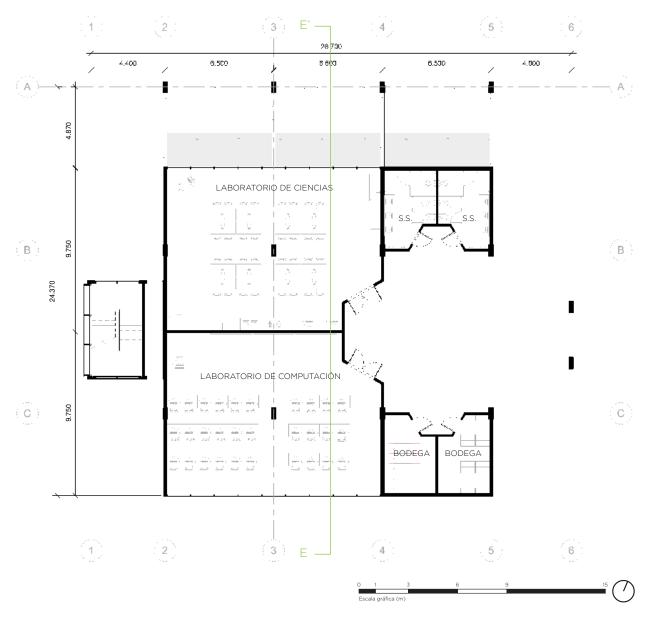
Planta arquitectónica de los talleres y laboratorios NPT 0,00 - 3,20 m
